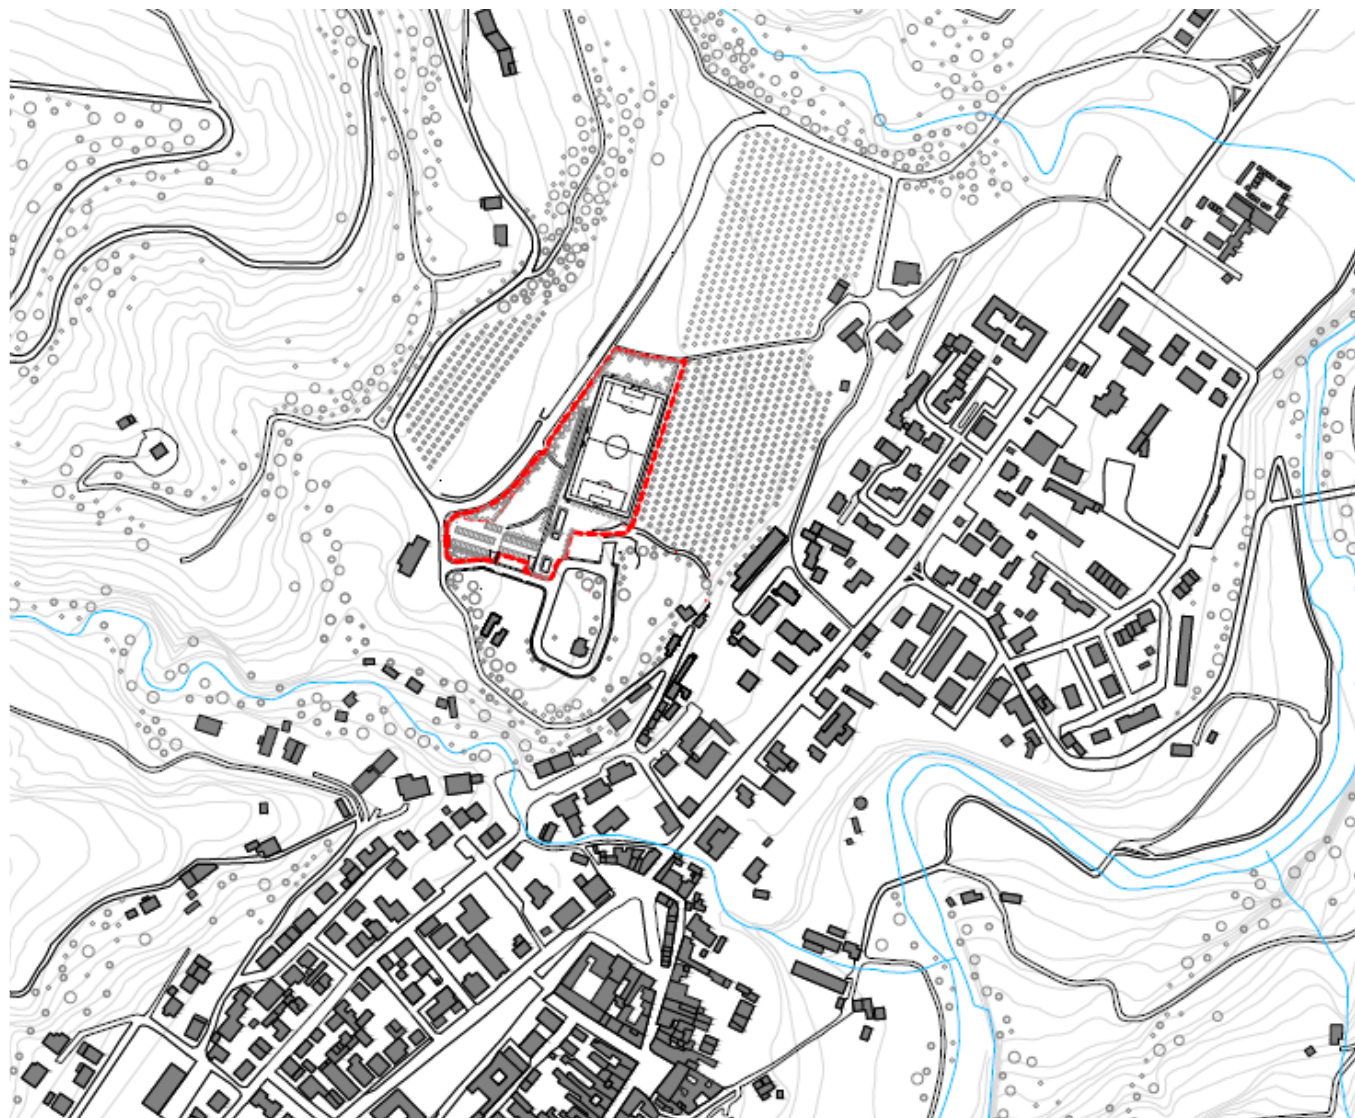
Tavola 02 Planimetria dell'area di progetto denominata Furina
